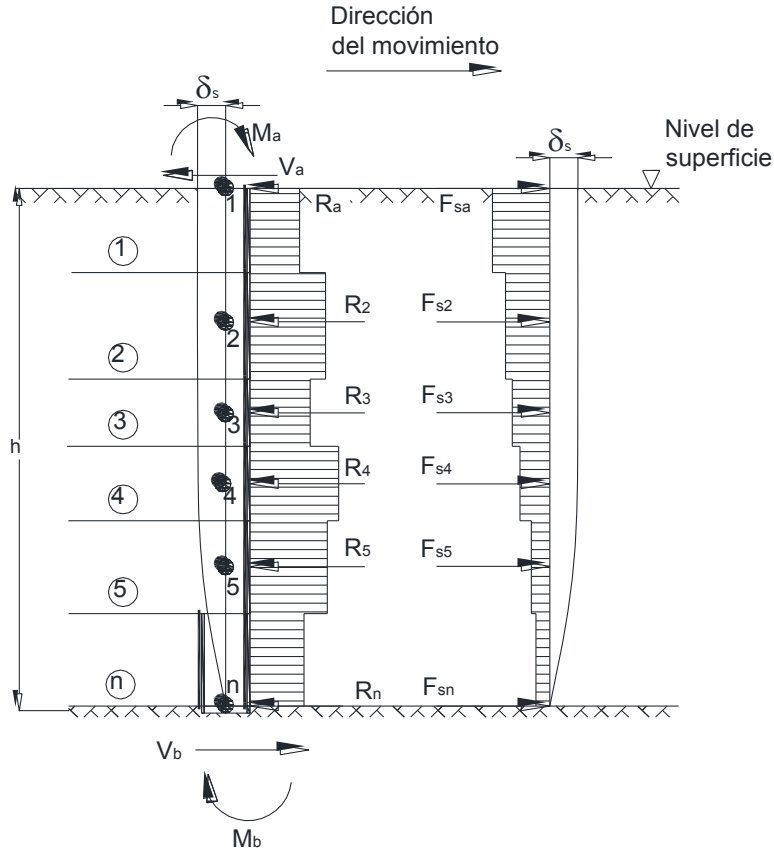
Interacción entre pila y suelo (Zeevaert, 1973)
